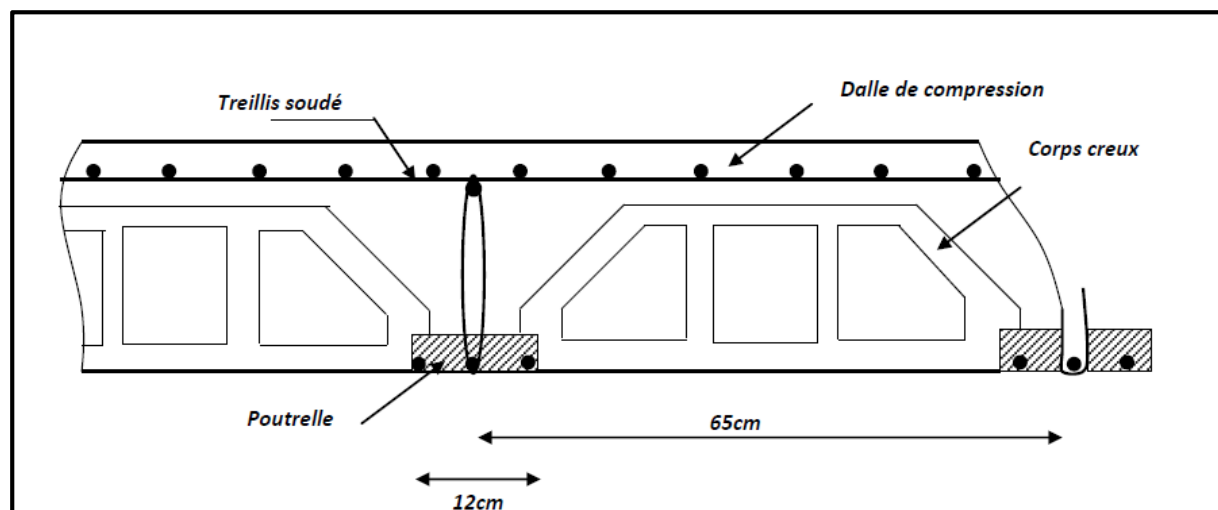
Coupe transversale d'un plancher en corps creux (16+4)
